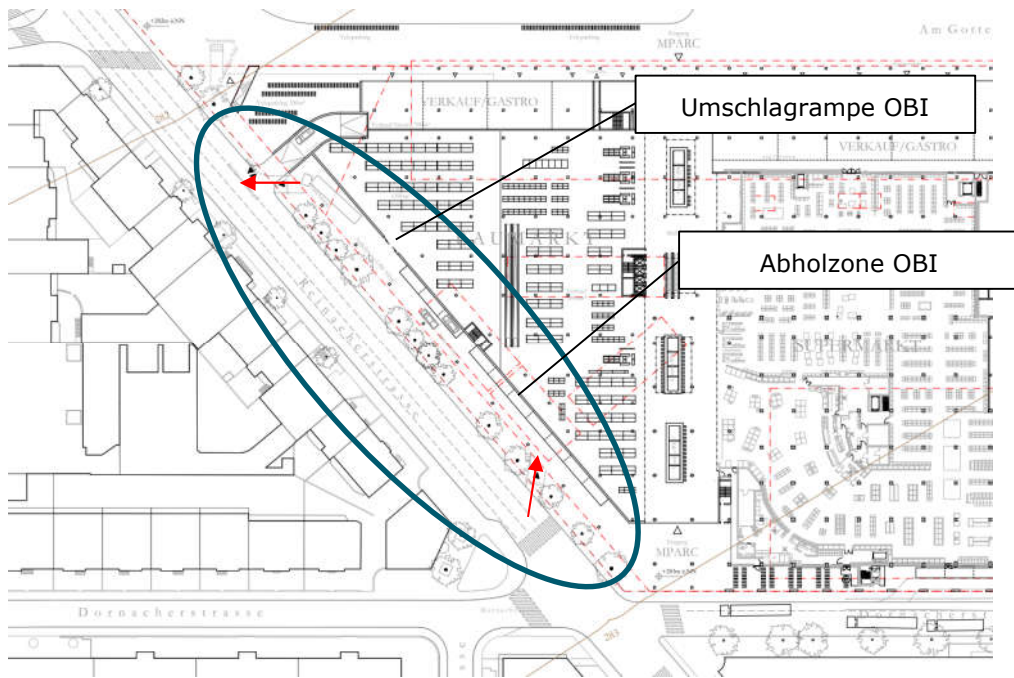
Situation Umschlag OBI (Quelle: Grundriss Erdgeschoss, Herzog & de Meuron 20.05.2019)
